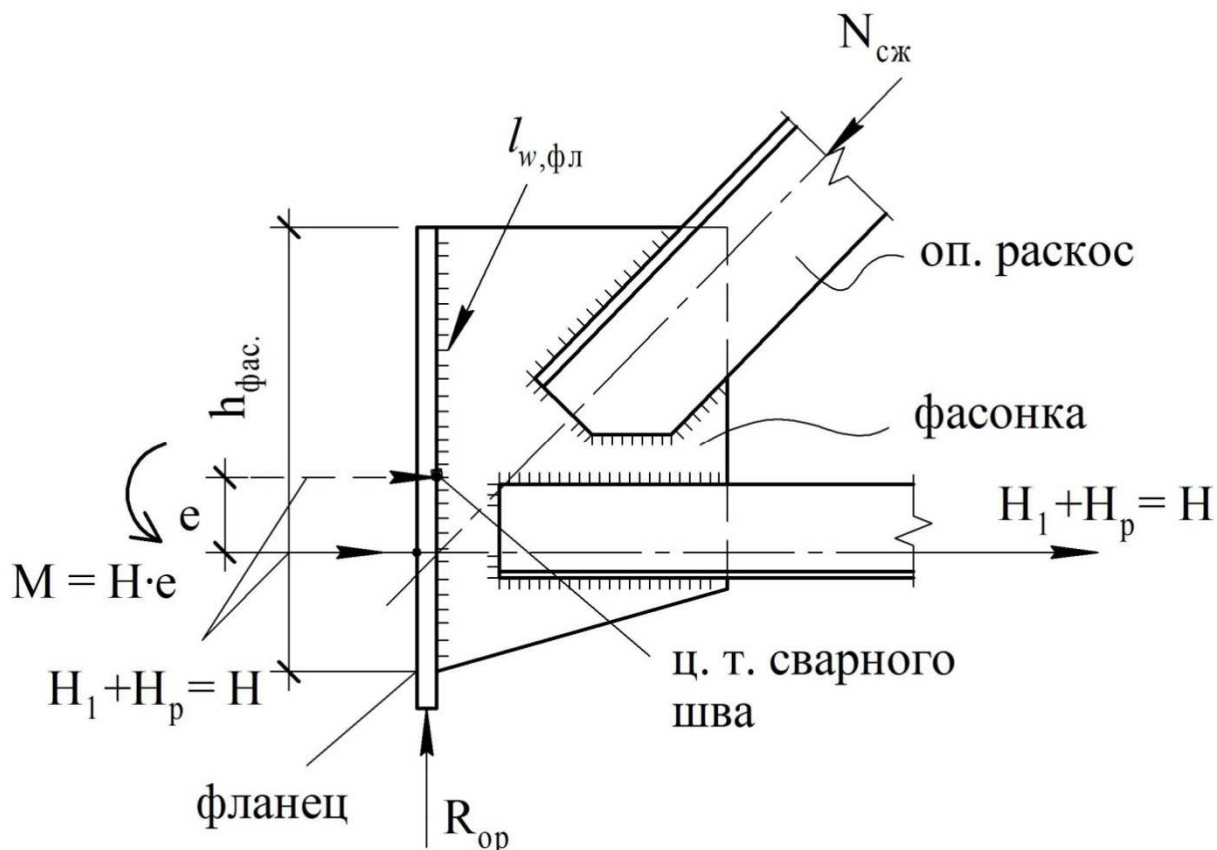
К проверке НДС сварного шва, соединяющего опорный фланец с фасонкой
